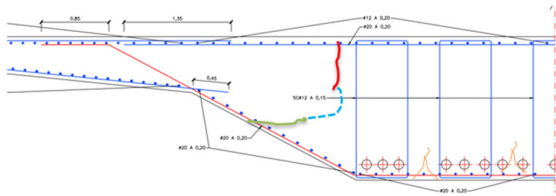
Esquema de grietas detectadas en el tablero. En Rojo, grieta inicial de plataforma; en verde, grieta en alma y el azul, grieta detectada con testigos.
